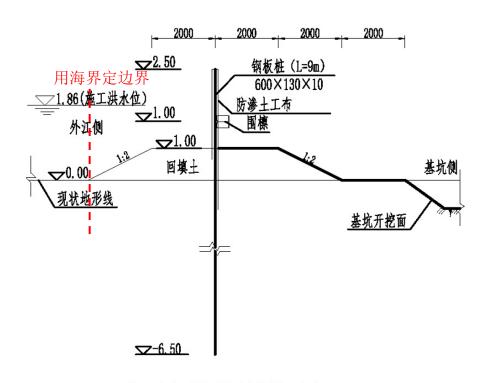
涵窦重建施工围堰断面图二用海界定示意图
